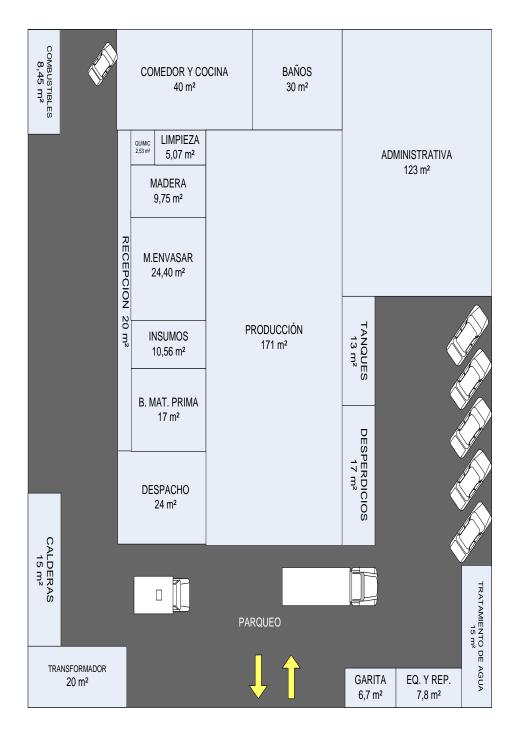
LAYOUT DE LA PLANTA 2
